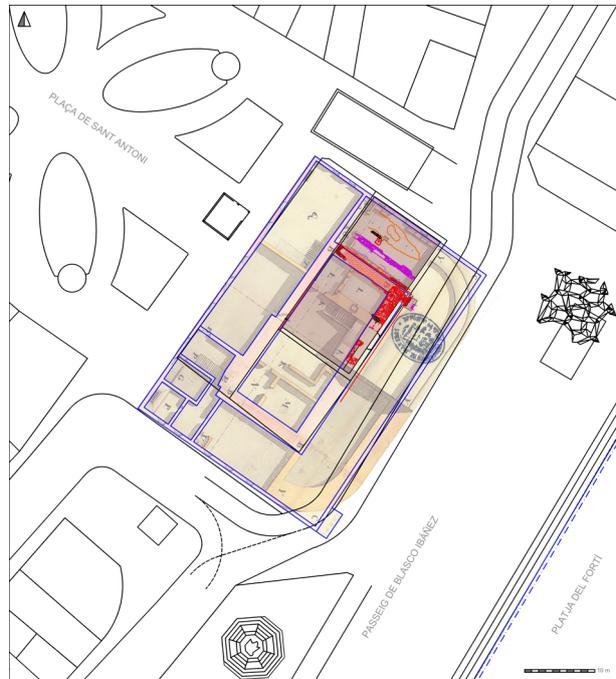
Planta de los elementos excavados del Fortí sobre plano topográfico actual del ayuntamiento y plano del proyecto de 1780. Trama urbana actual en negro, área excavada en sombra gris, y planta de las estructuras existentes en 1780 en azul.
